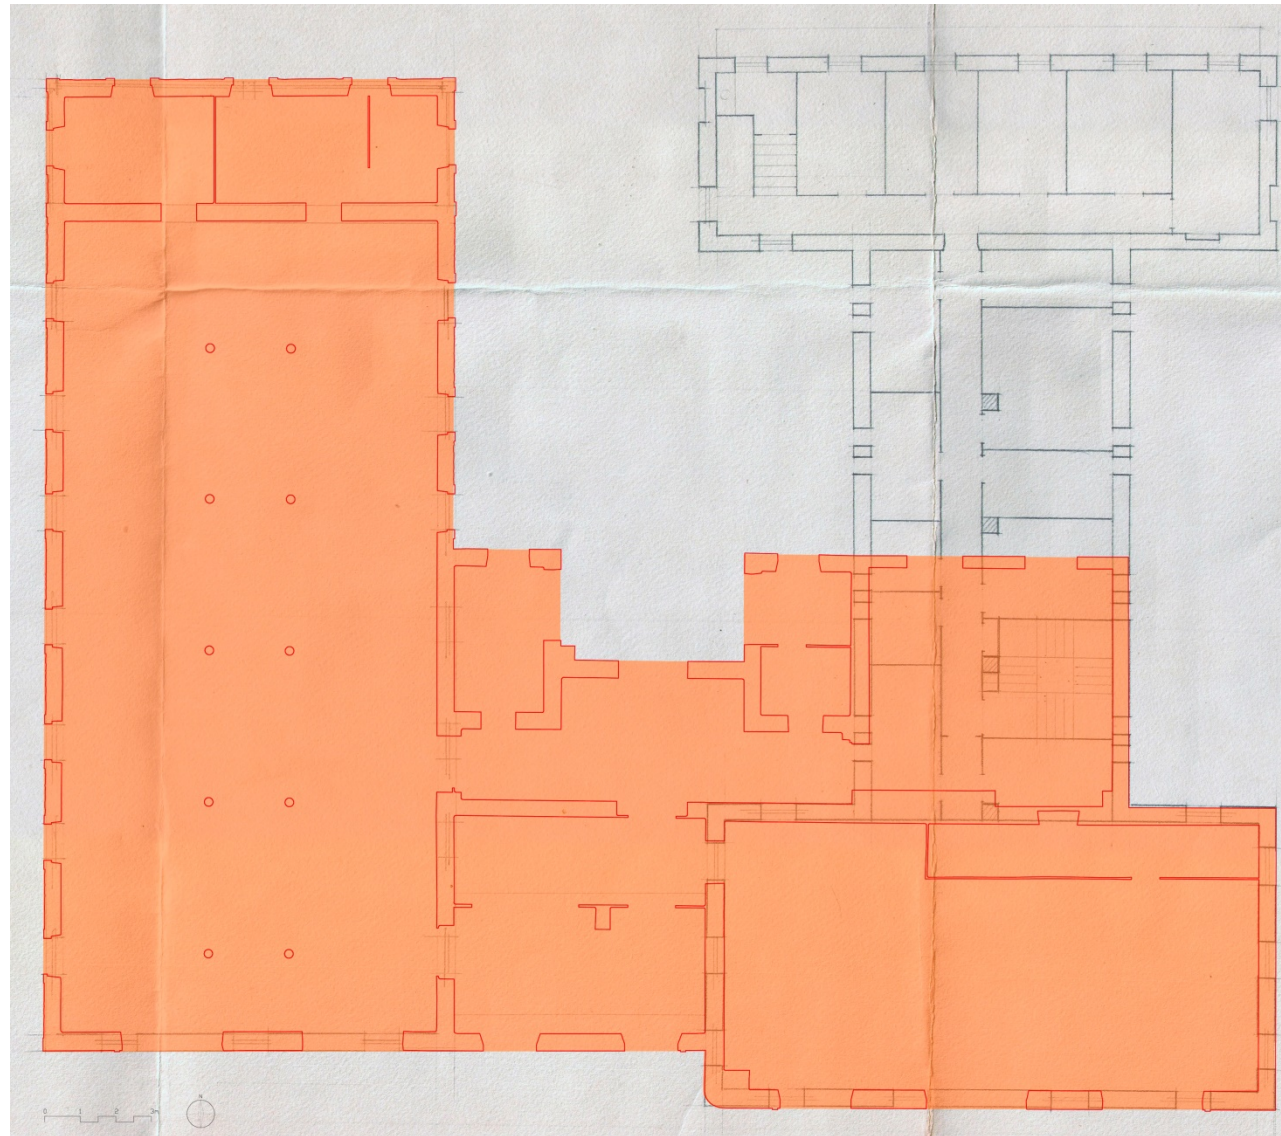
Plano 1ª Planta Pabellón de La Purísima. Superposición de levantamiento planimétrico con Escáner Laser 3D (Rojo) y Plano año 1933. Color naranja, delimita construcción actual. Año 2016.
